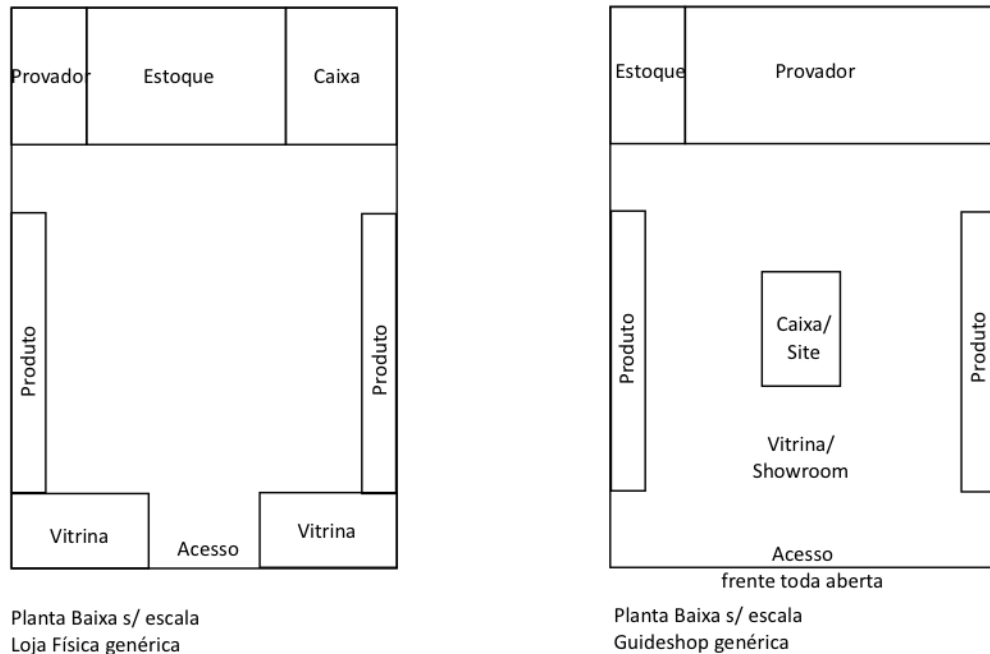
Planta Baixa. Situação genérica, sem escala.
